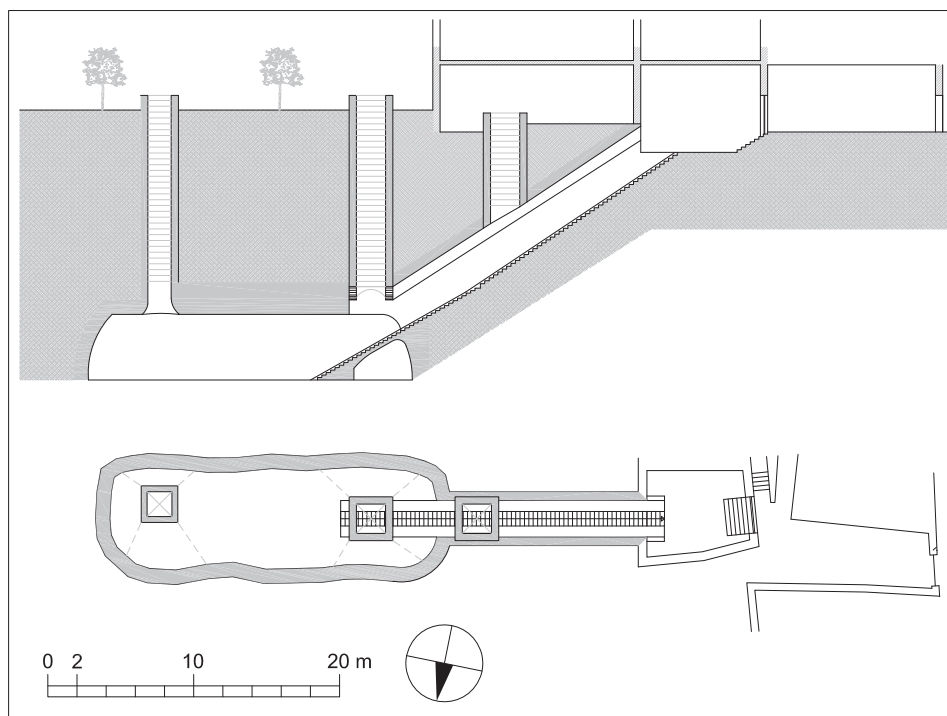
Comiziano, cantina C3. Pianta e sezione longitudinale.
